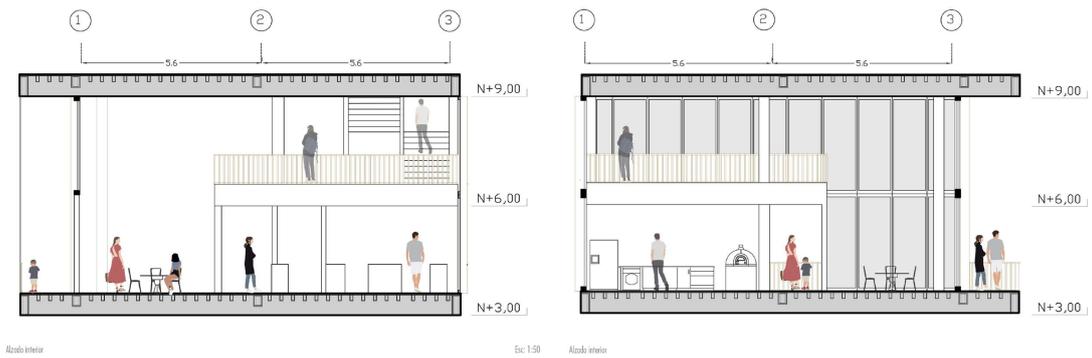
Alzado interior 3 y 4 pizzería. Elaboración propia
